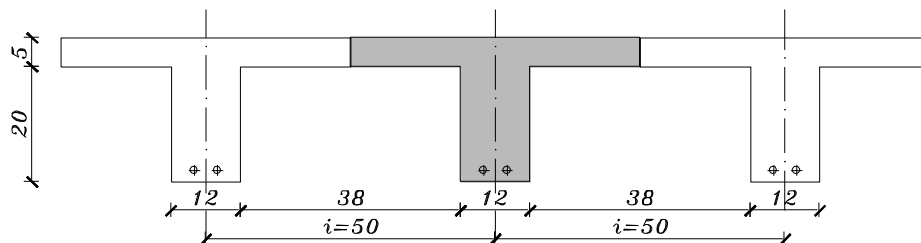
Sezione teorica di calcolo di un solaio latero-cemento
